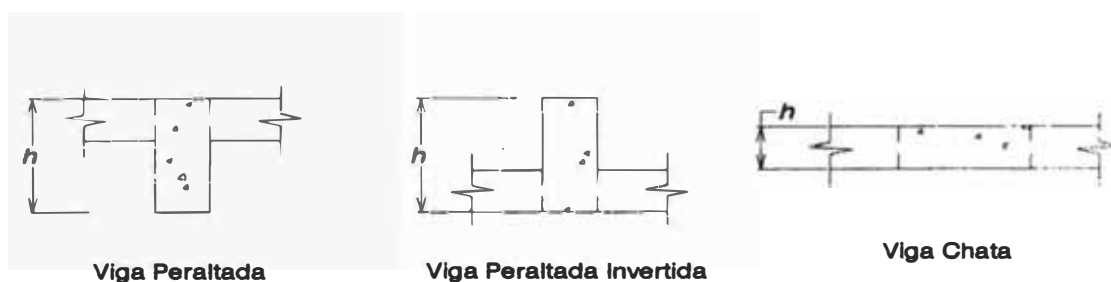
Tipos de Vigas ( $h$  : peralte de la viga)
